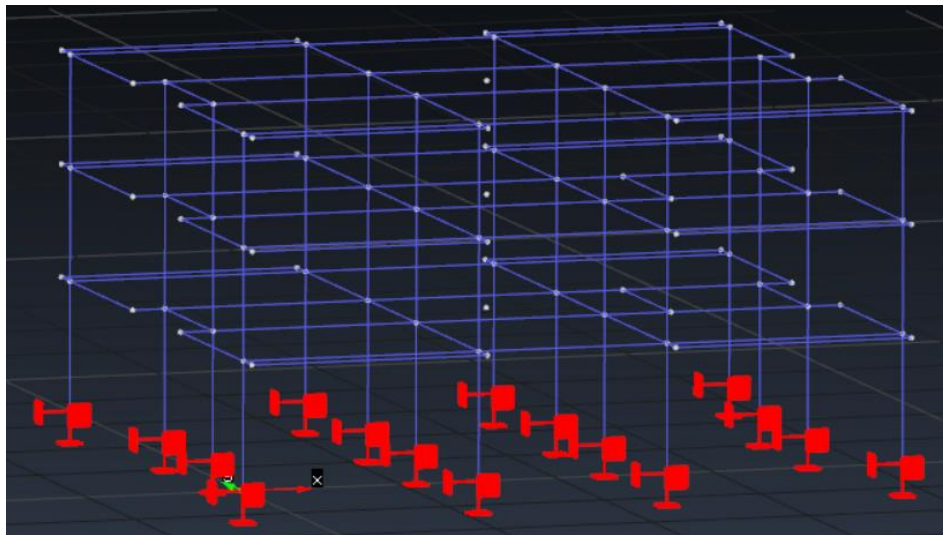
Modelo de la estructura donde los planos rojos representan las restricciones o empotramiento de los nodos de los pilares de planta baja. (Fuente: GiD)
